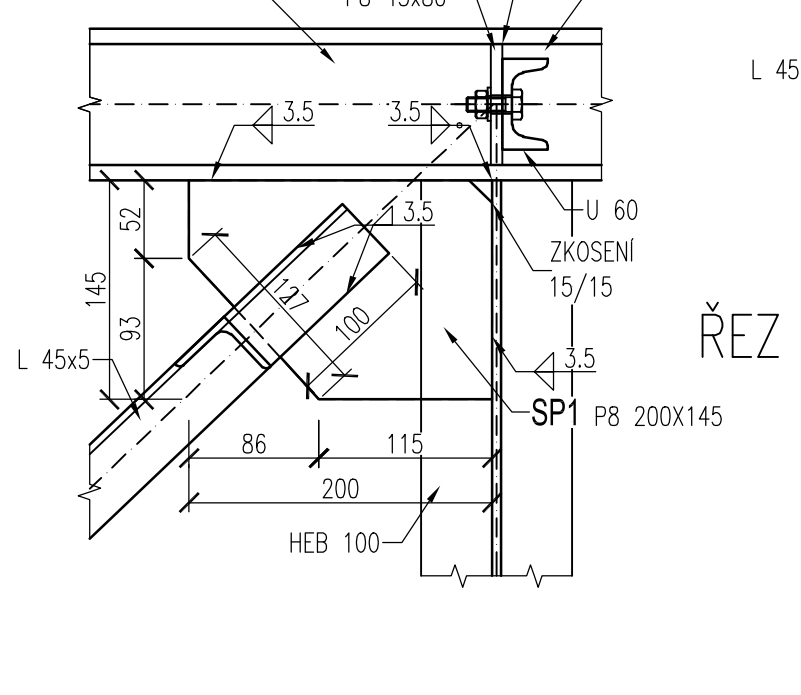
RÁMOVÉHO SPOJE M 1:5
